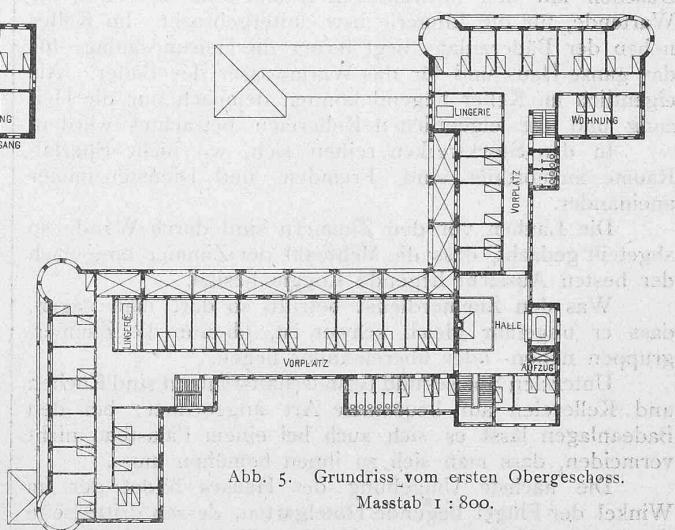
Grundriss vom ersten Obergeschoss.
